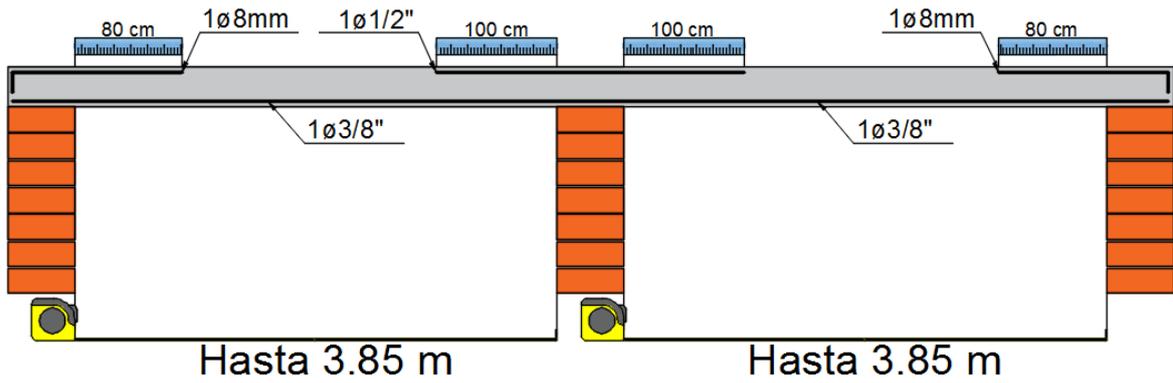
Refuerzo de vigueta hasta 3.85 m por tramo.
